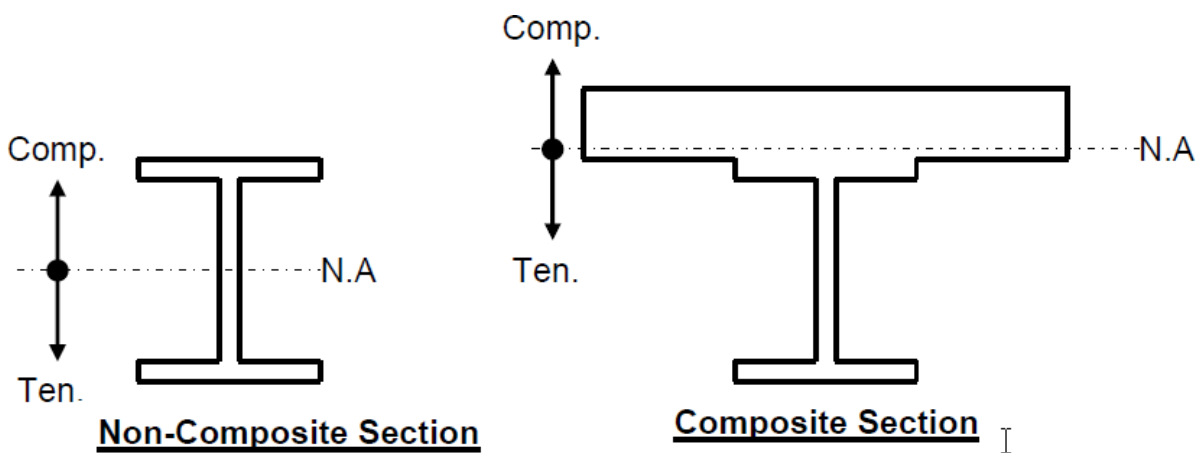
localisation de l'axe neutre dans une poutre mixte et non Mixte.
